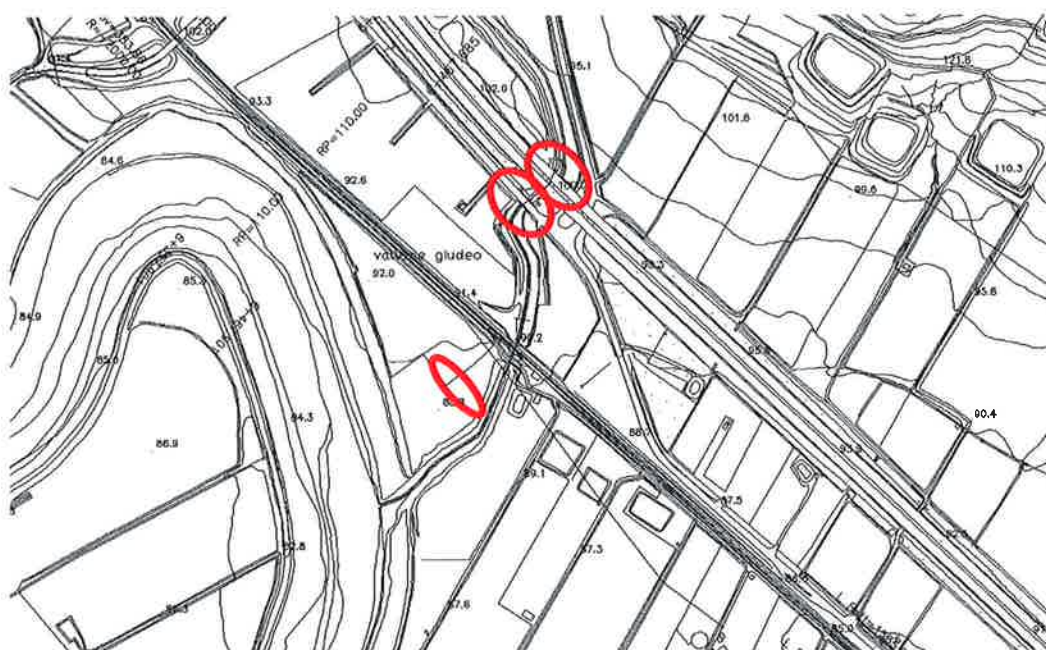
Individuazione planimetrica dei due attraversamenti stradali- Vallone Giudeo
